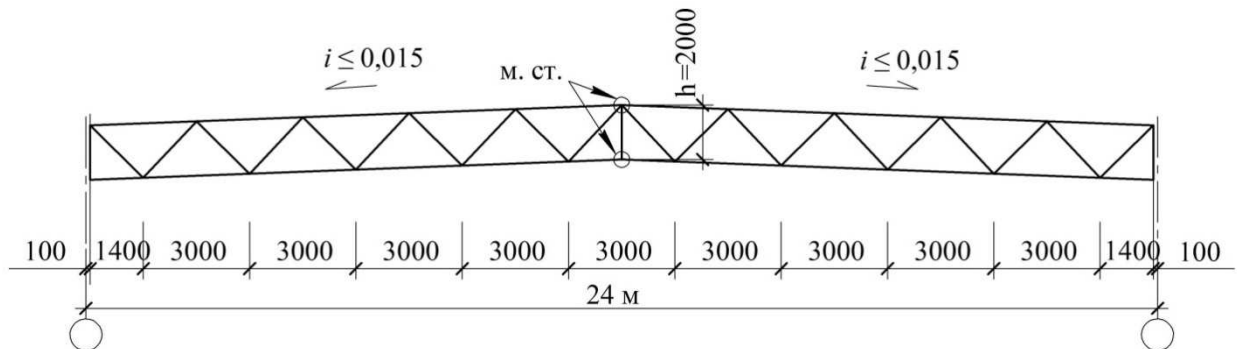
Конструктивная схема стропильной фермы (или ригеля рамы типа "Молодечно")
